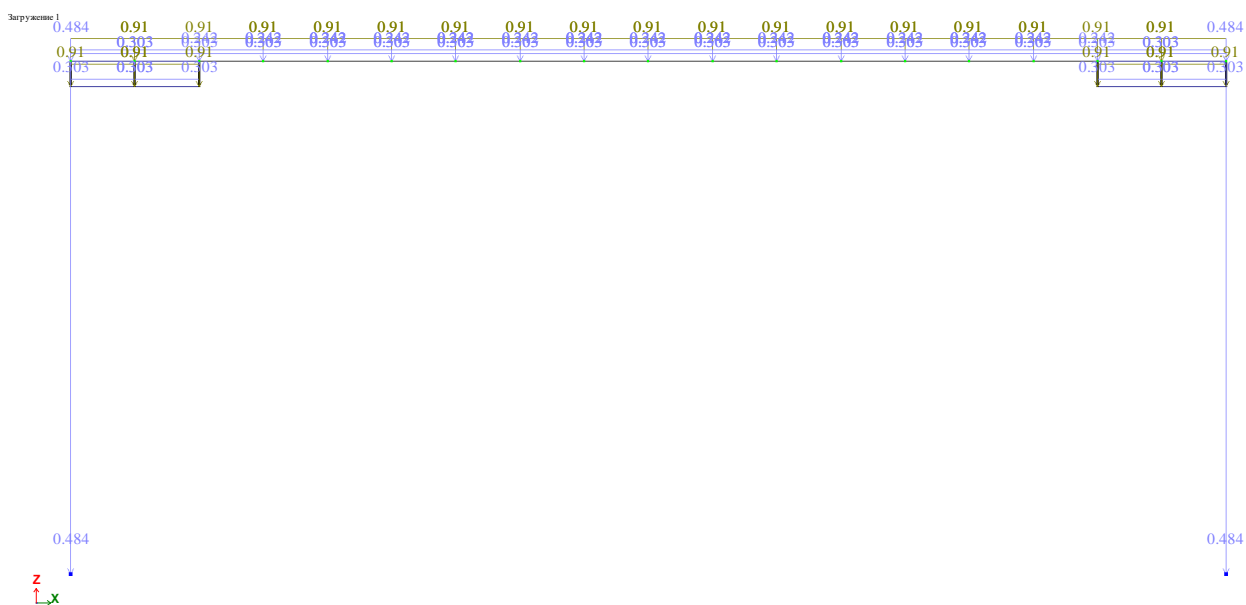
Схема нагружения на перекрытие в проекции XOZ
